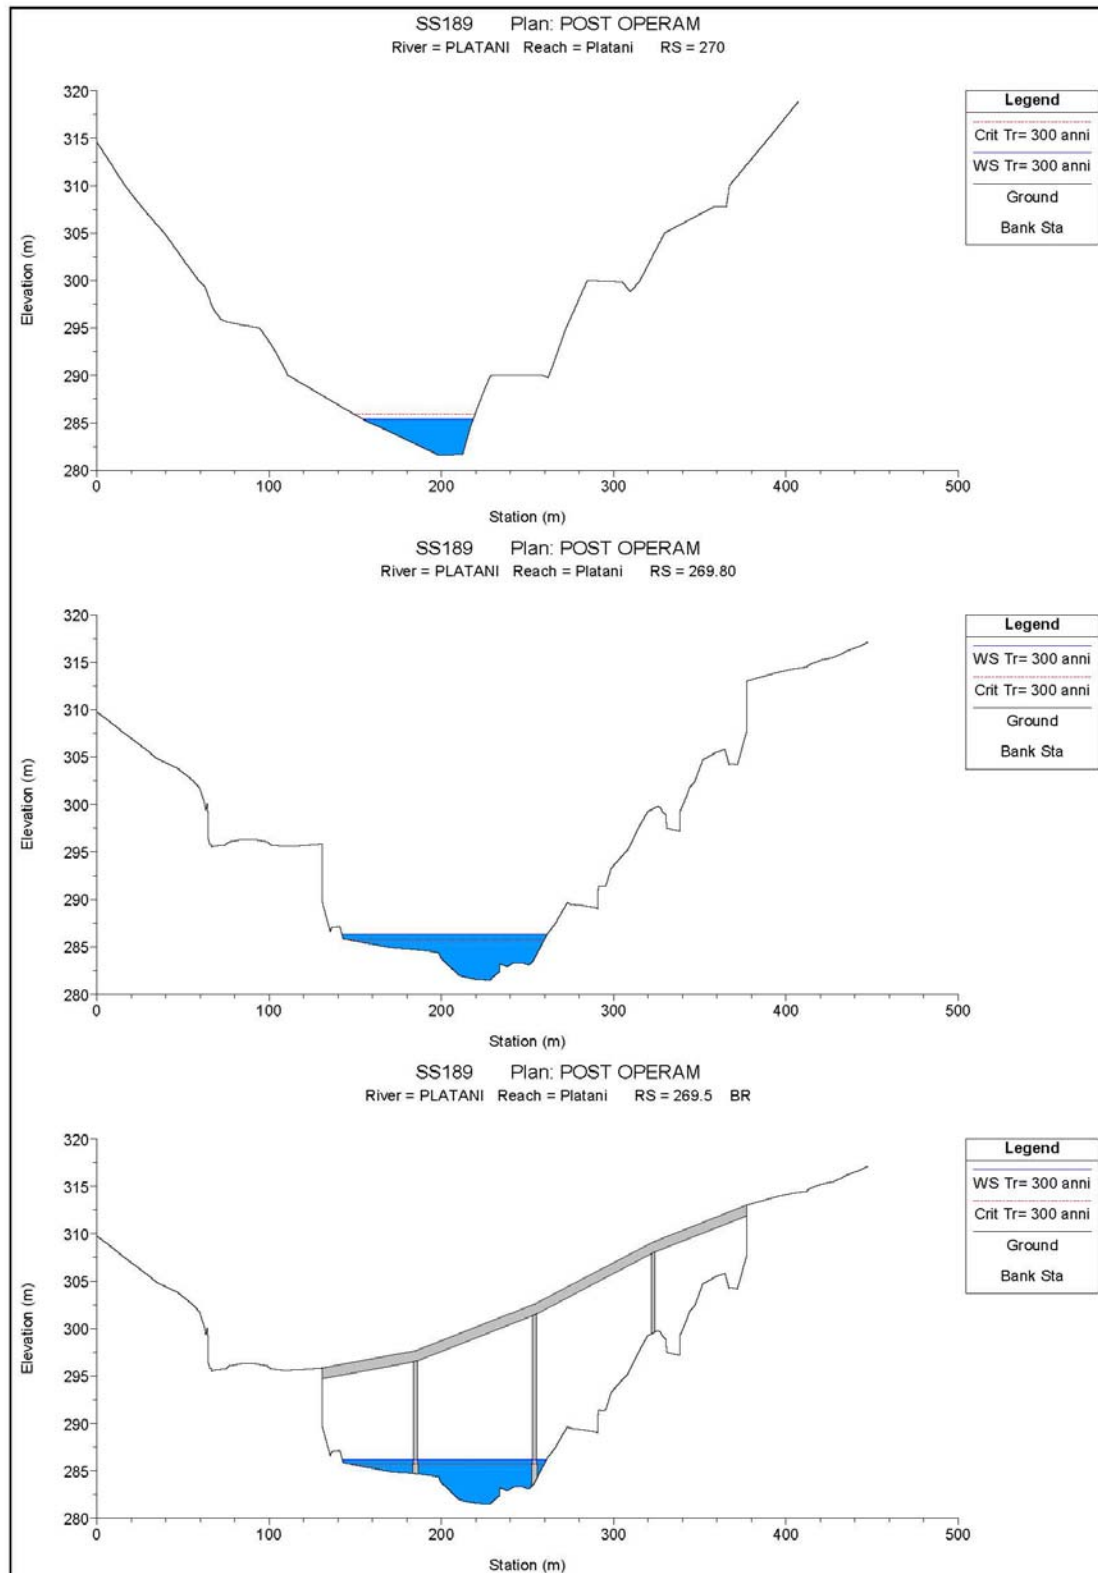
Fiume Platani: Sezioni P.O. interessate dalle opere di sistemazione idraulica
